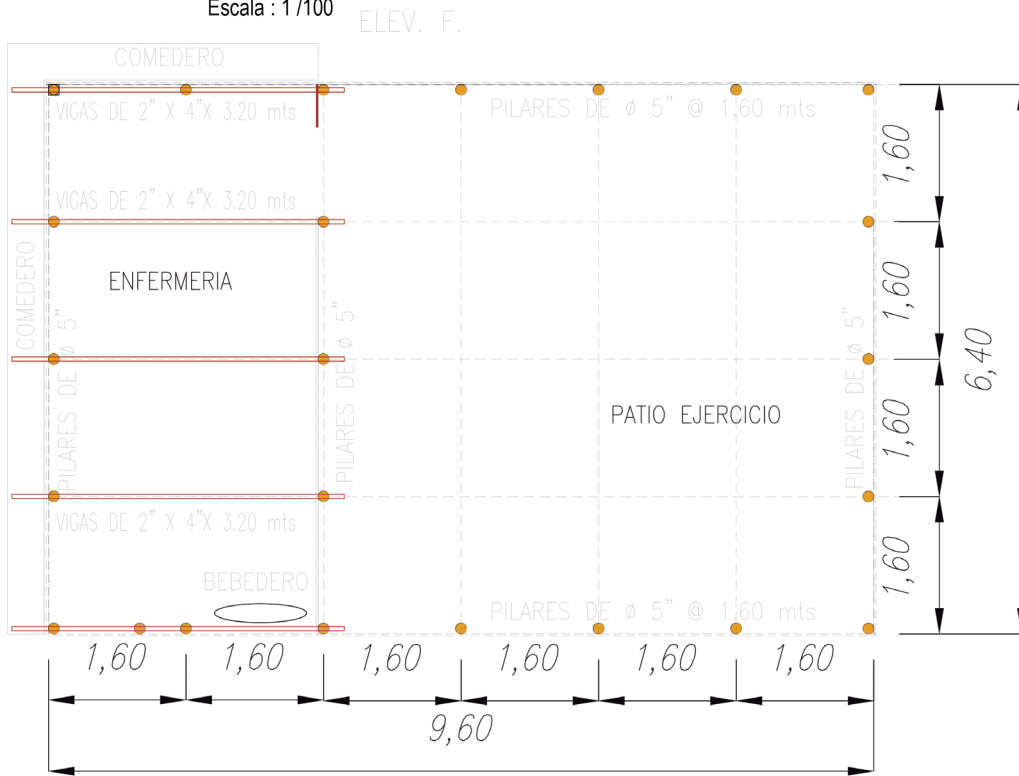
Planta de arquitectura, estructura y cubiertas corral de enfermería y/o cuarentena.
